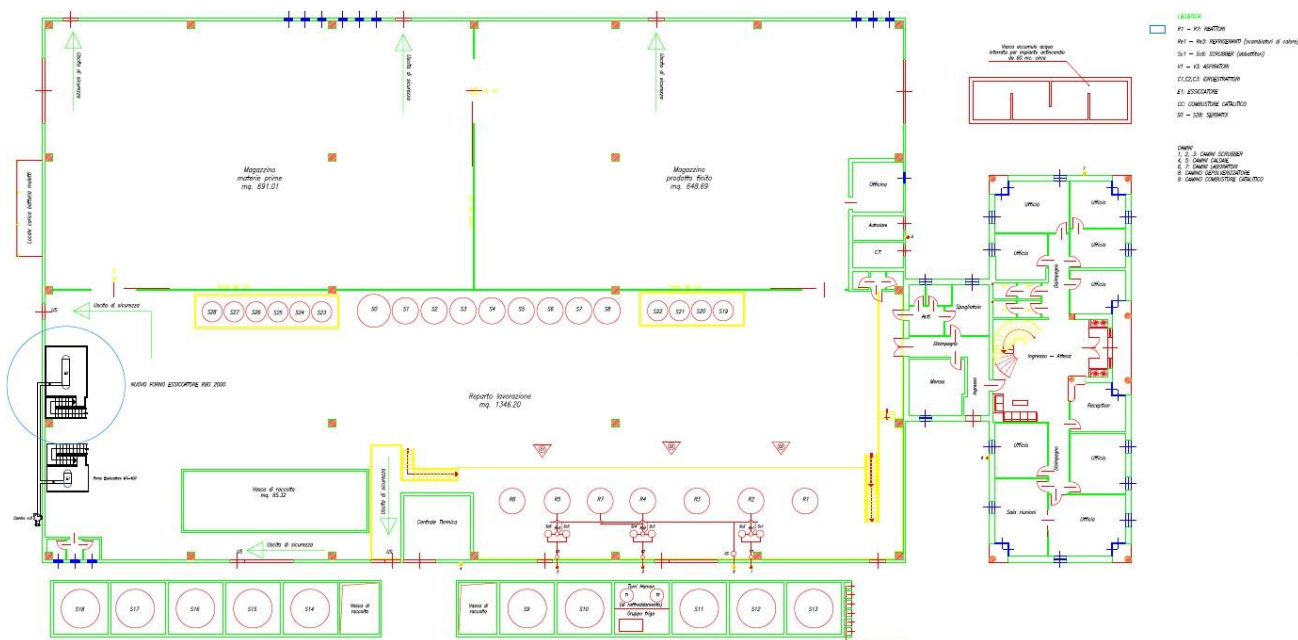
planimetria di progetto con individuazione del nuovo essiccatore
